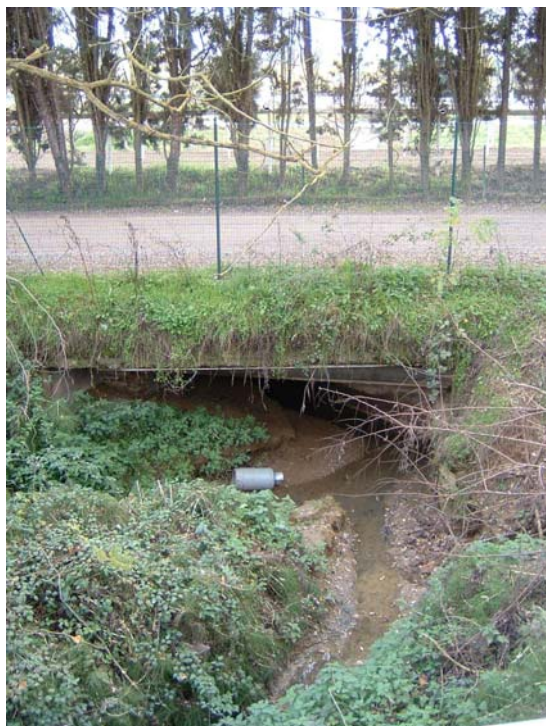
attraversamento della pista dell'ippodromo (sezione SO460)
